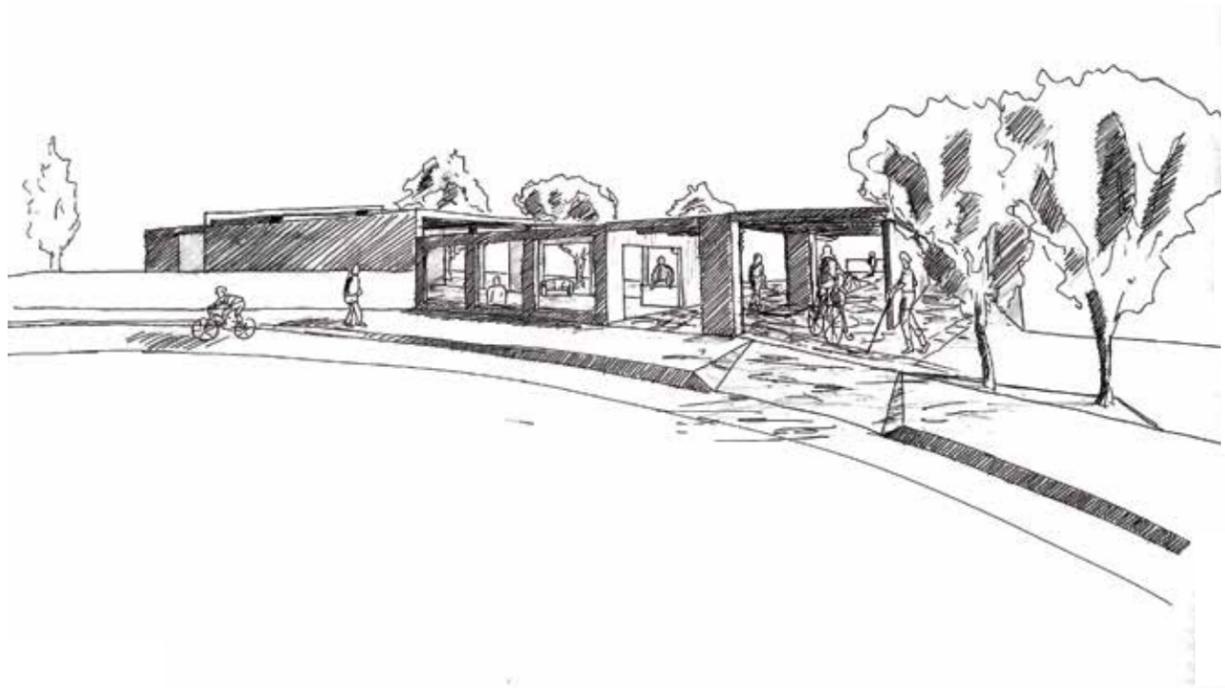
Maqueta, vista oeste; Escala 1:100.
